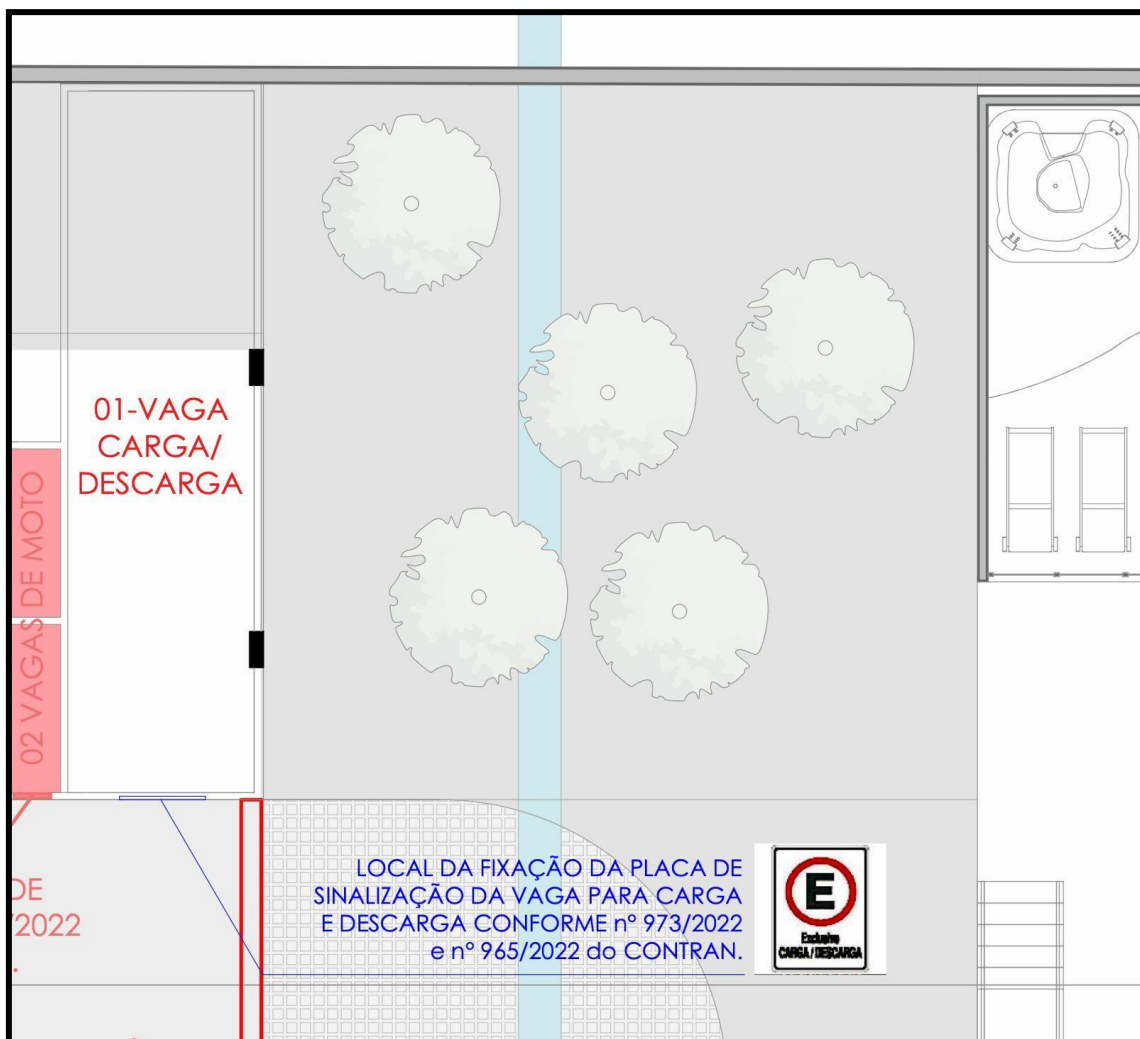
Detalhes da vaga Carga/Descarga - Pavimento subsolo. Fonte: Projeto Arquitetônico, 2025.
